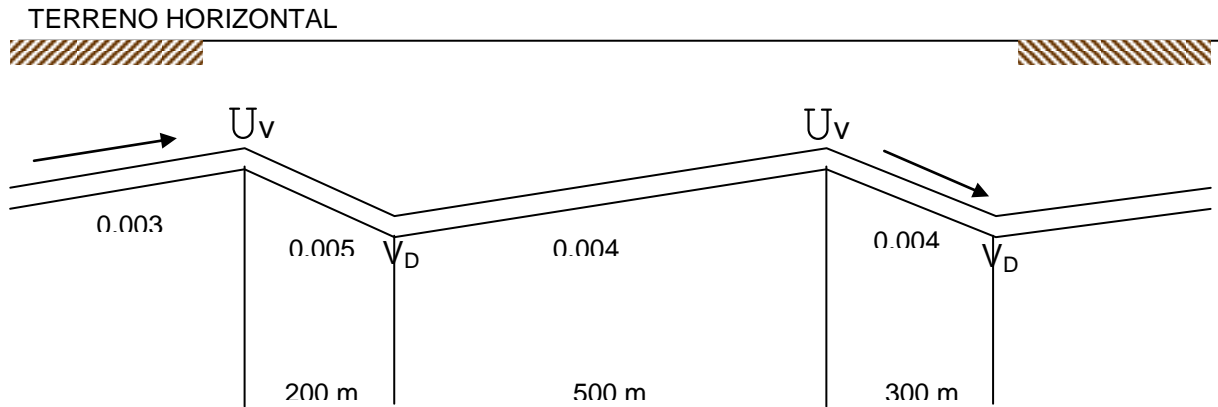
Tubulação com trechos ligeiramente inclinados em terreno plano
